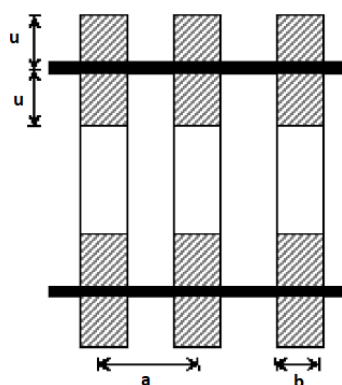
Área de apoio da travessa monobloco (Pita, 2006)
